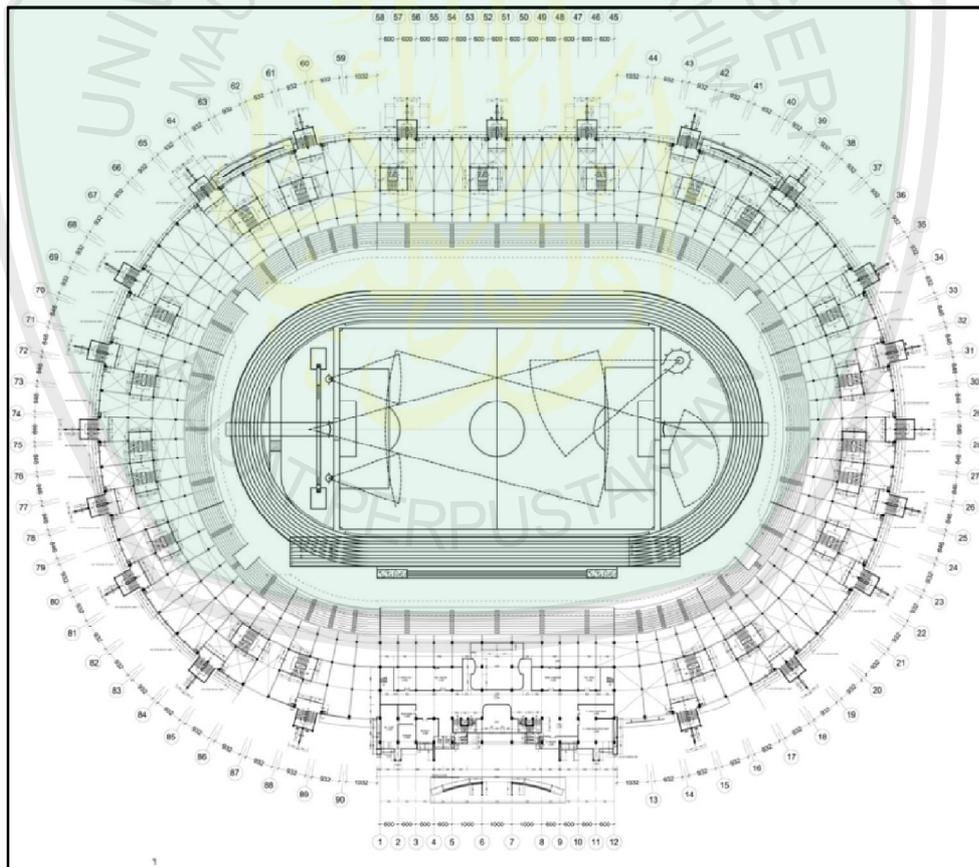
Detail Lantai 1 (Ruangan Lantai 1 SSC dan Sirkulasi)
